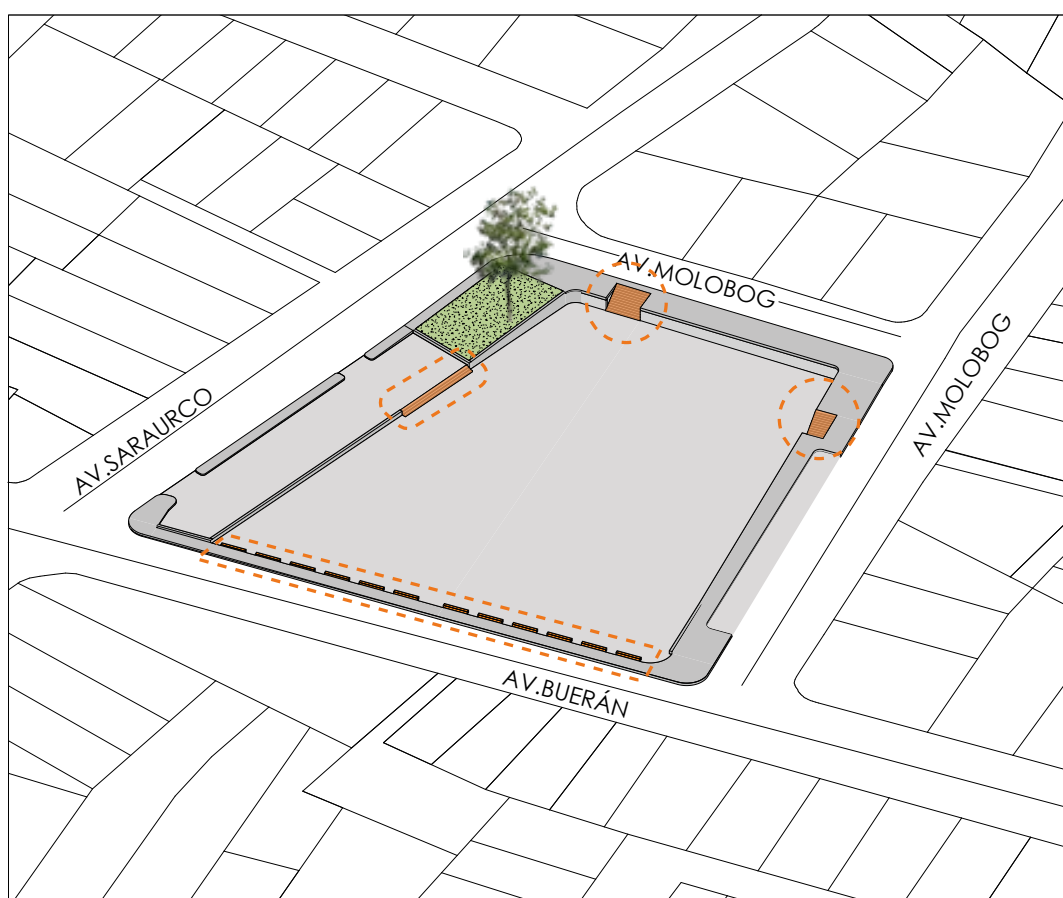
Mejoramiento y eliminación de barreras arquitectónicas Elaboración: Propia
